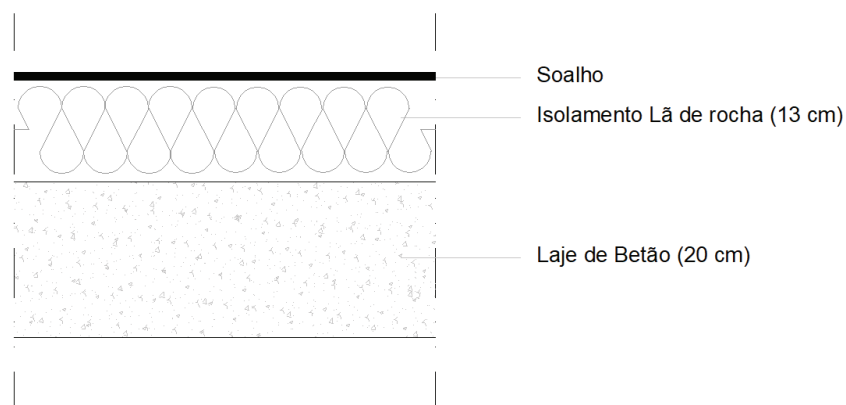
Pormenor construtivo do pavimento interior tipo IV (cota 13.62 - *classroom*)
